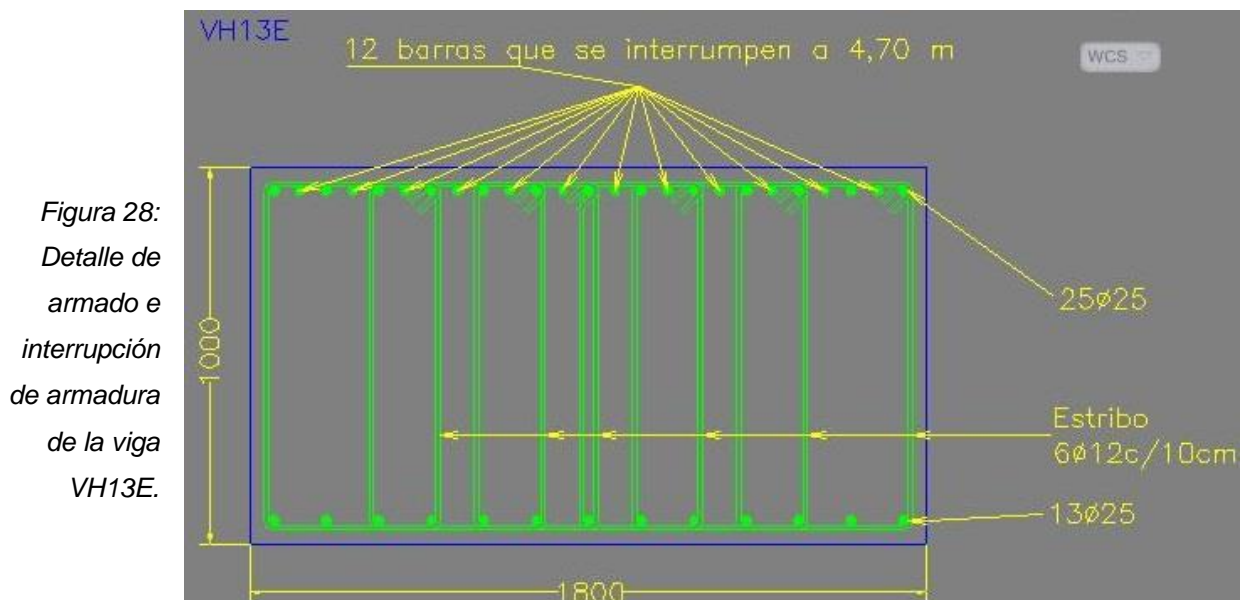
Detalle de armado e interrupción de armadura de la viga VH13E.
